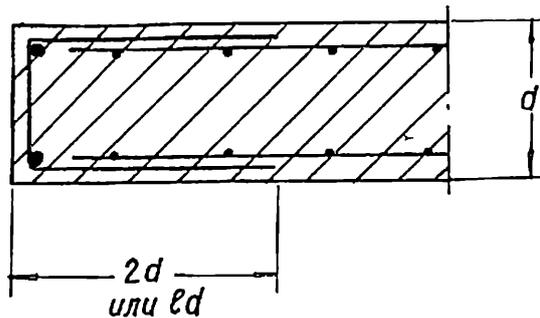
8. Вертикальные грани стен должны охватываться U-образными хомутами или сетками
